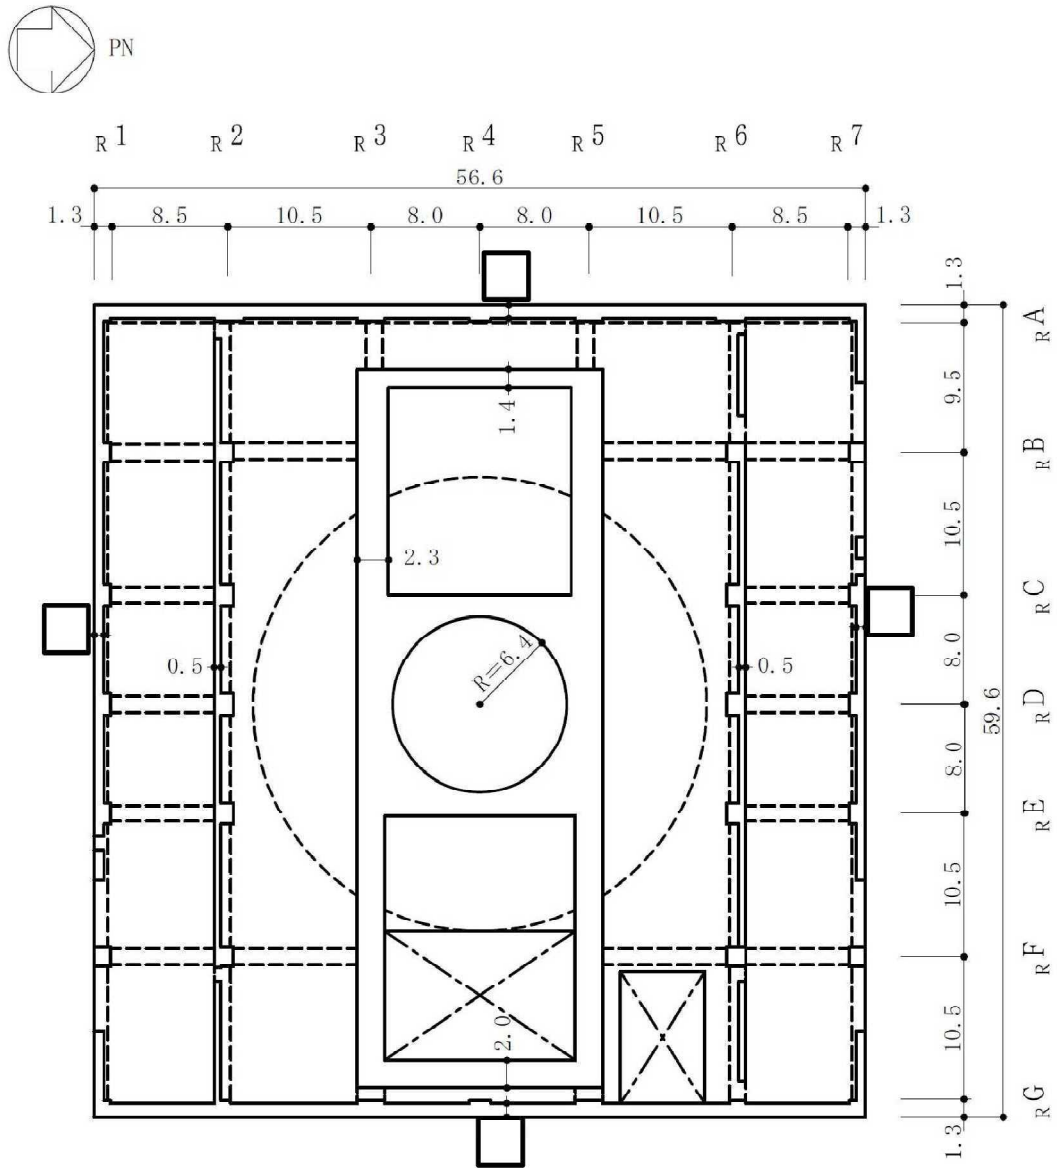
原子炉建屋の概略平面図 (1F, T.M.S.L. 12.3m) (4/9)
